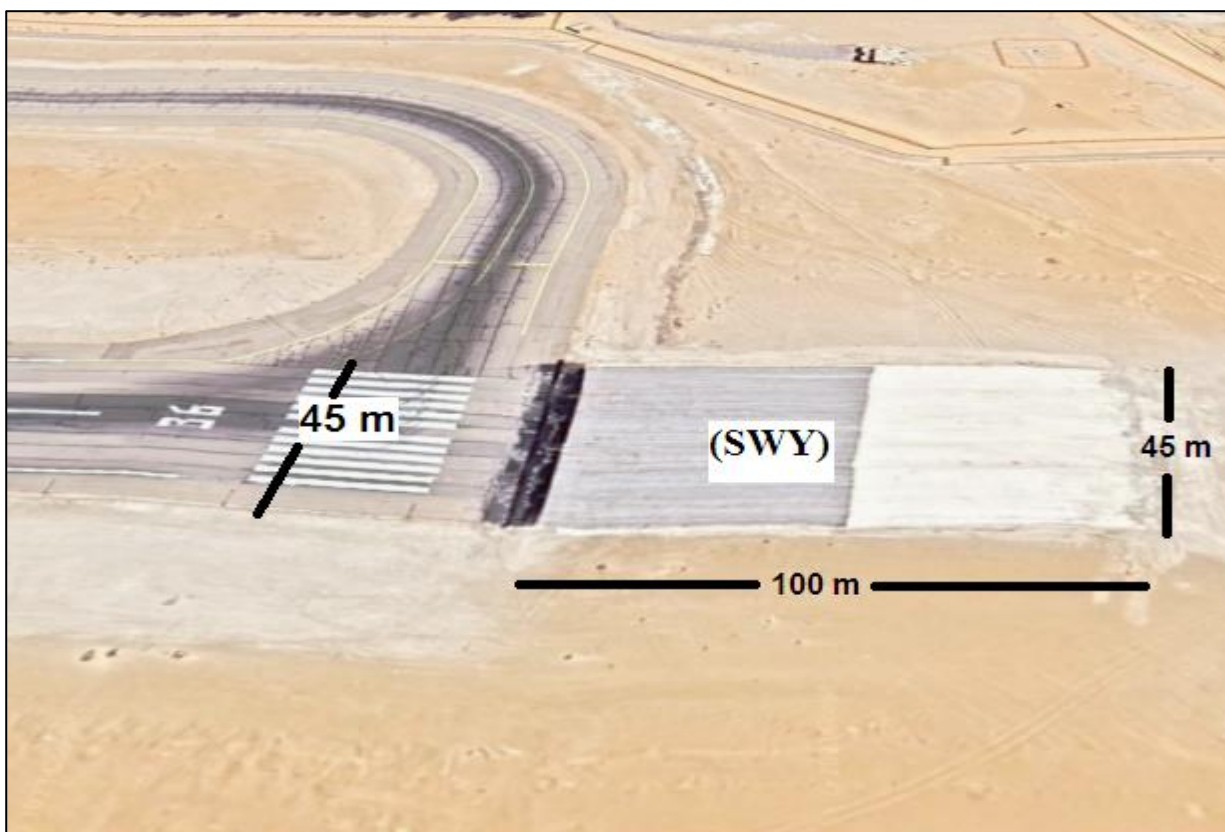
Dimensions du SWY et largeur de la piste 18/36. [29]
